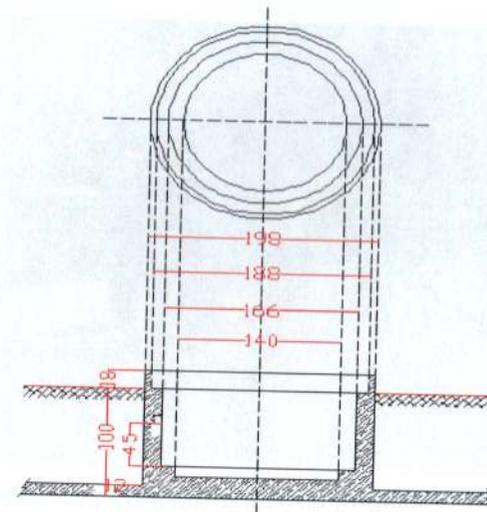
Planta e Vista de frente em corte do Gasómetro PUXTIL
